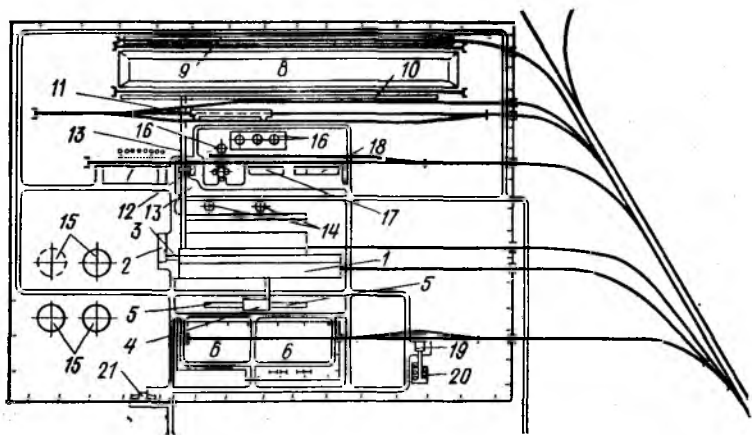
Схема генерального плана ТЭЦ на угле:
